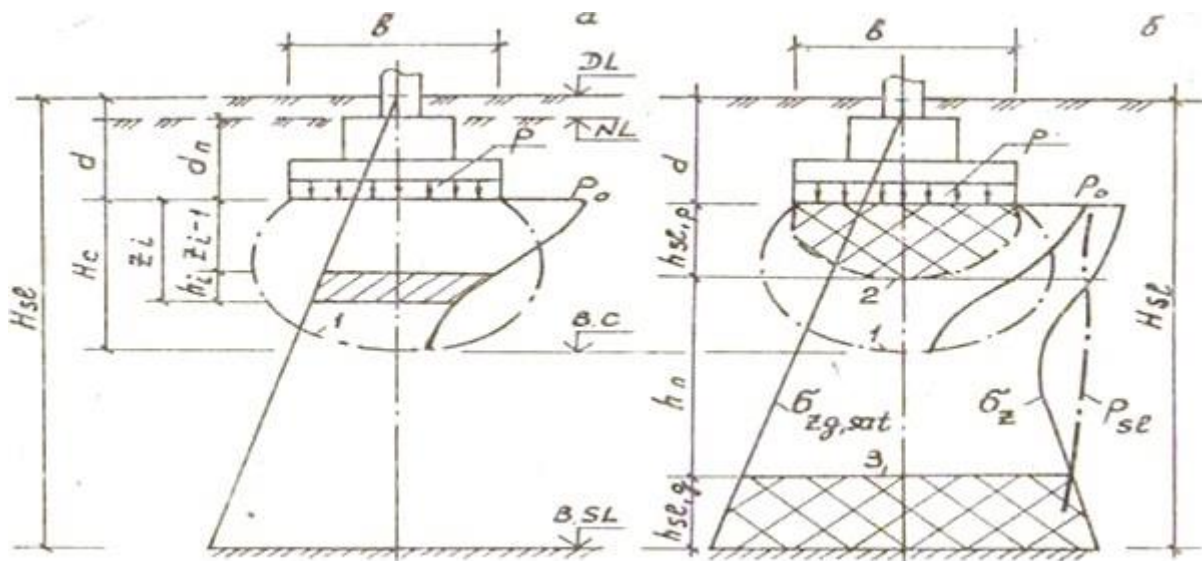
Схемы для определения осадки (а) и просадки (б) основания фундамента и границы: 1 - сжимаемой толщи; 2 - деформируемой зоны; 3 - области просадок от собственного веса грунта
